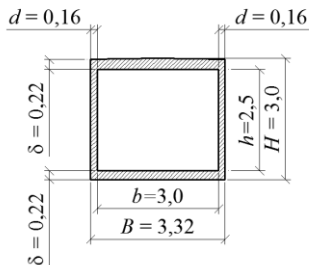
Поперечное сечение типового звена водопропускной трубы ЗП 16.100-F
